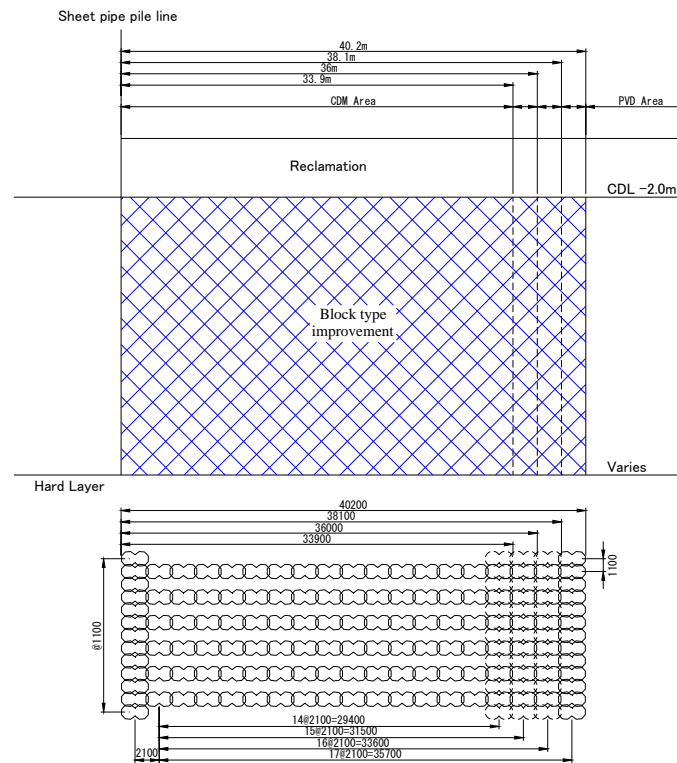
CDM 杭の配置平面図及び横断面図の詳細
